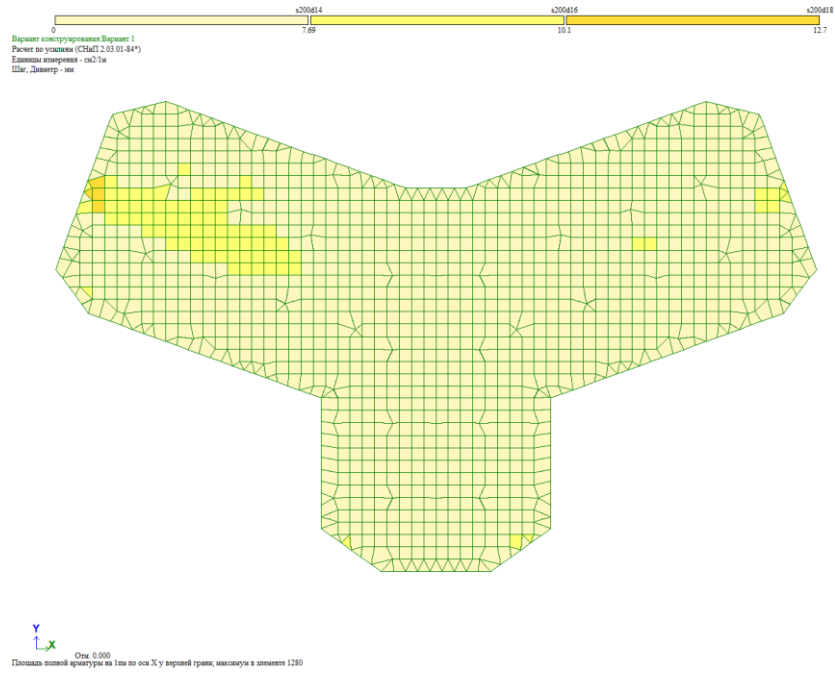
Площадь арматуры по оси X у верхней грани
